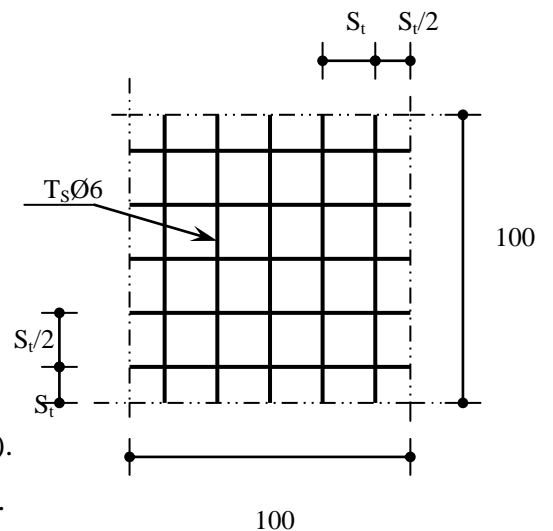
Disposition constructive des armatures de la dalle de compression
